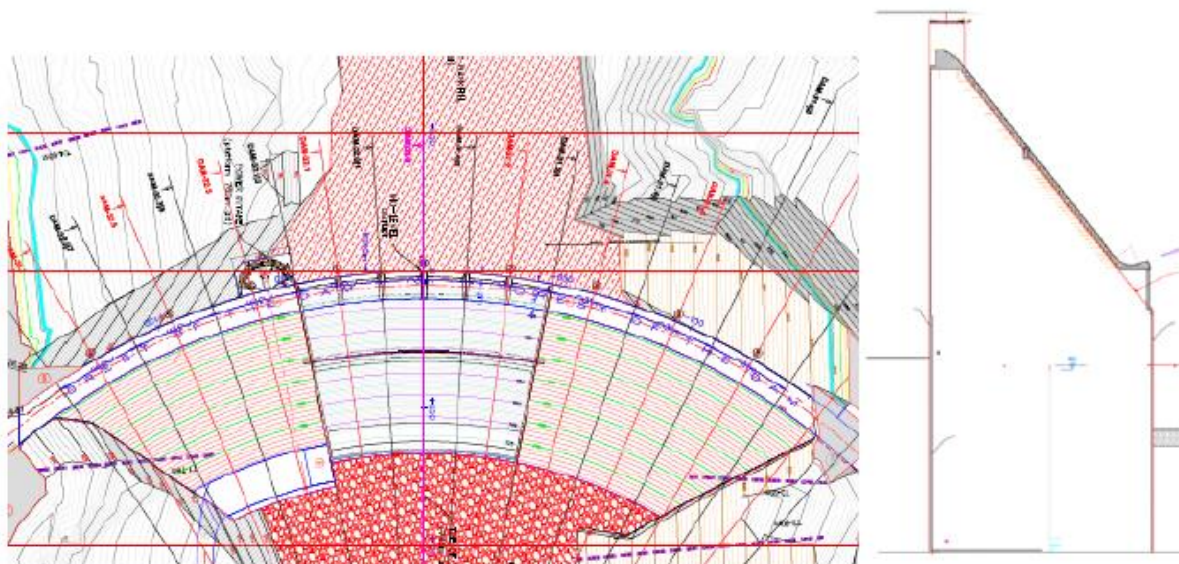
Vista en planta y sección transversal del bloque central de la presa. (Fuente: ANDRIAN [4])
